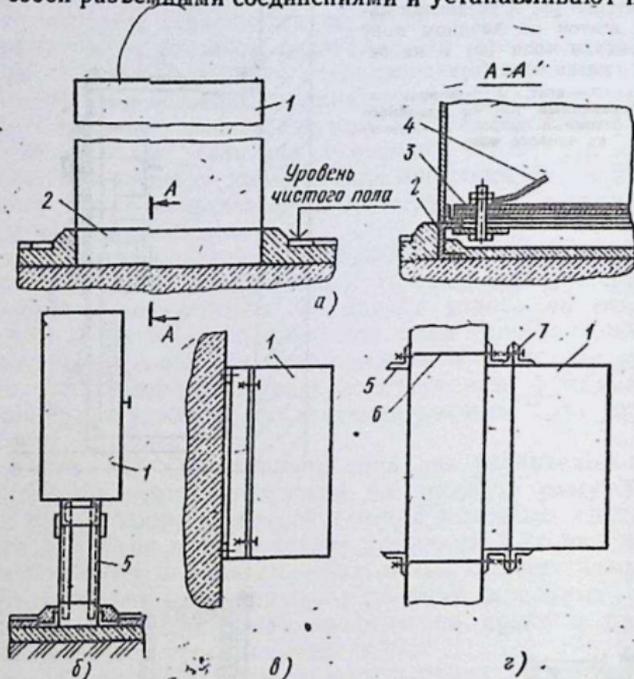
Установка шкафного щита на полу (а, б), стене (в) и колонне (г):
